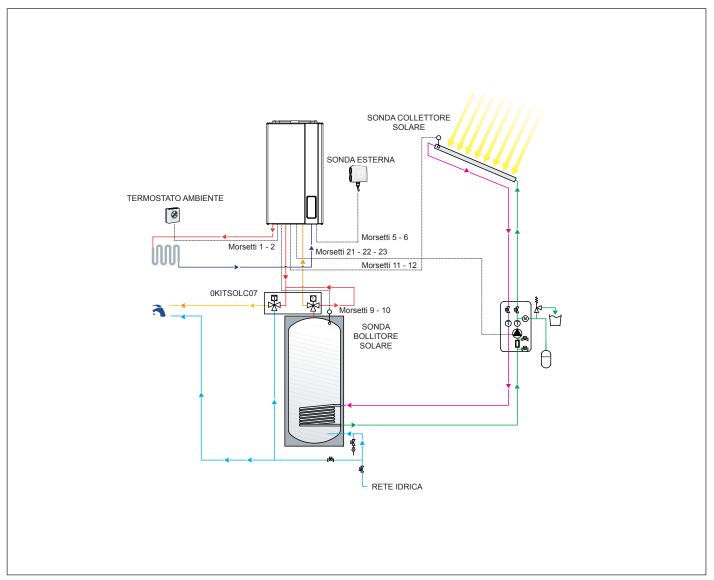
Schema di collegamento impianto solare a circolazione forzata con caldaia combinata
